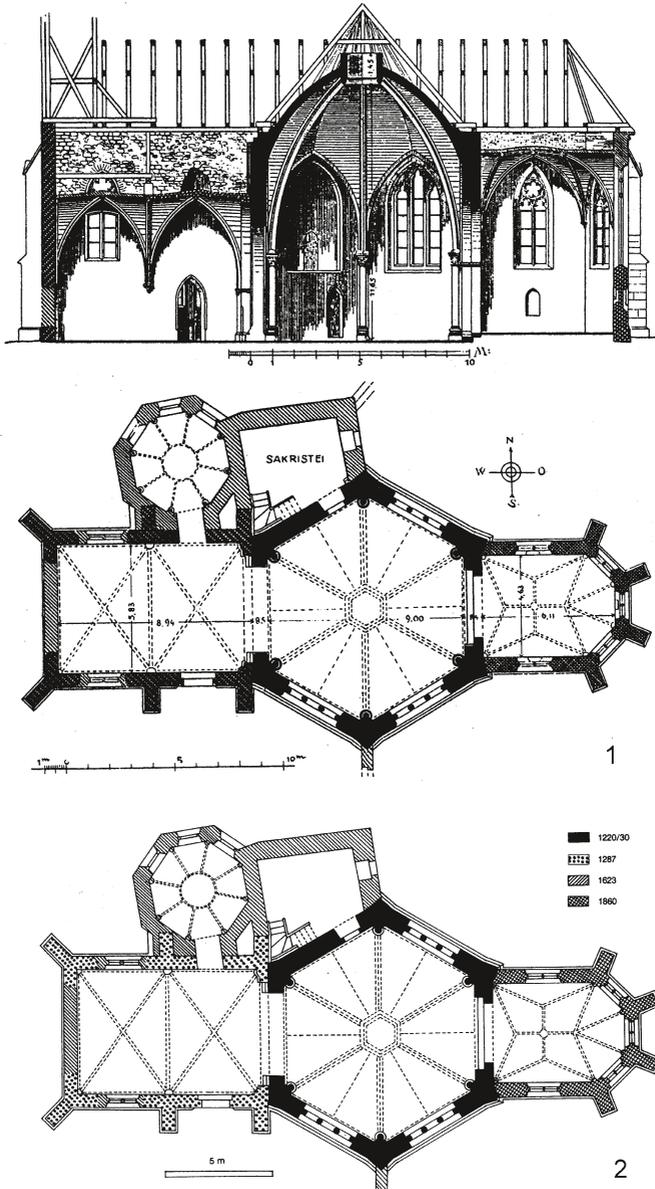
Regensburg, Katharinenspital. 1 Grundriss und Längsschnitt (nach Mader 1933, 134 Abb. 100); 2 Grundriss mit Eintrag der Bauzeiten (nach Strobel/Weis 1994, 130).
